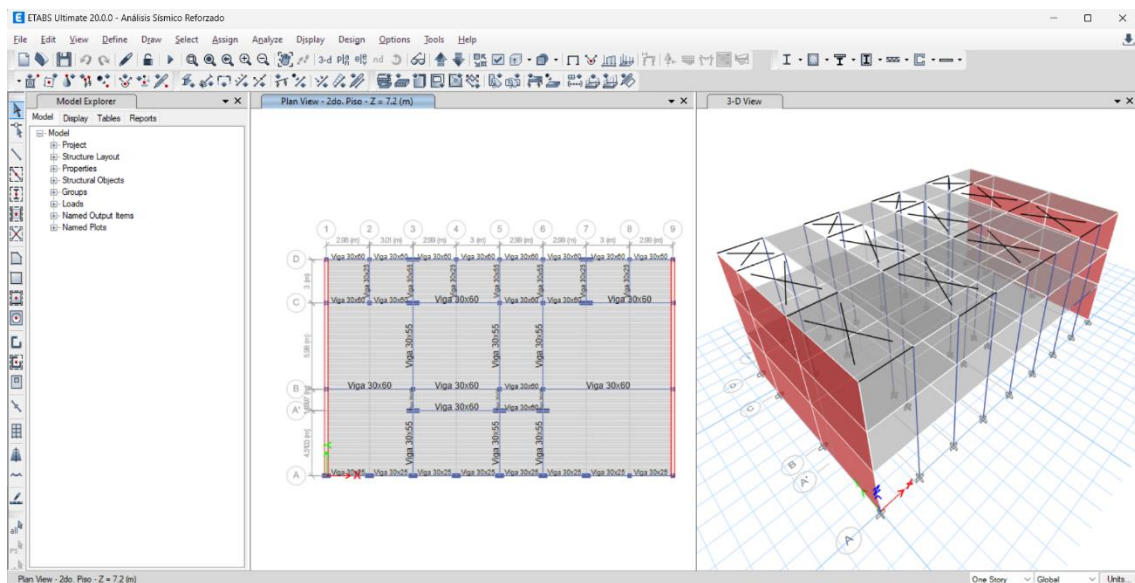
Modelamiento Estructural del Refuerzo de la Edificación
